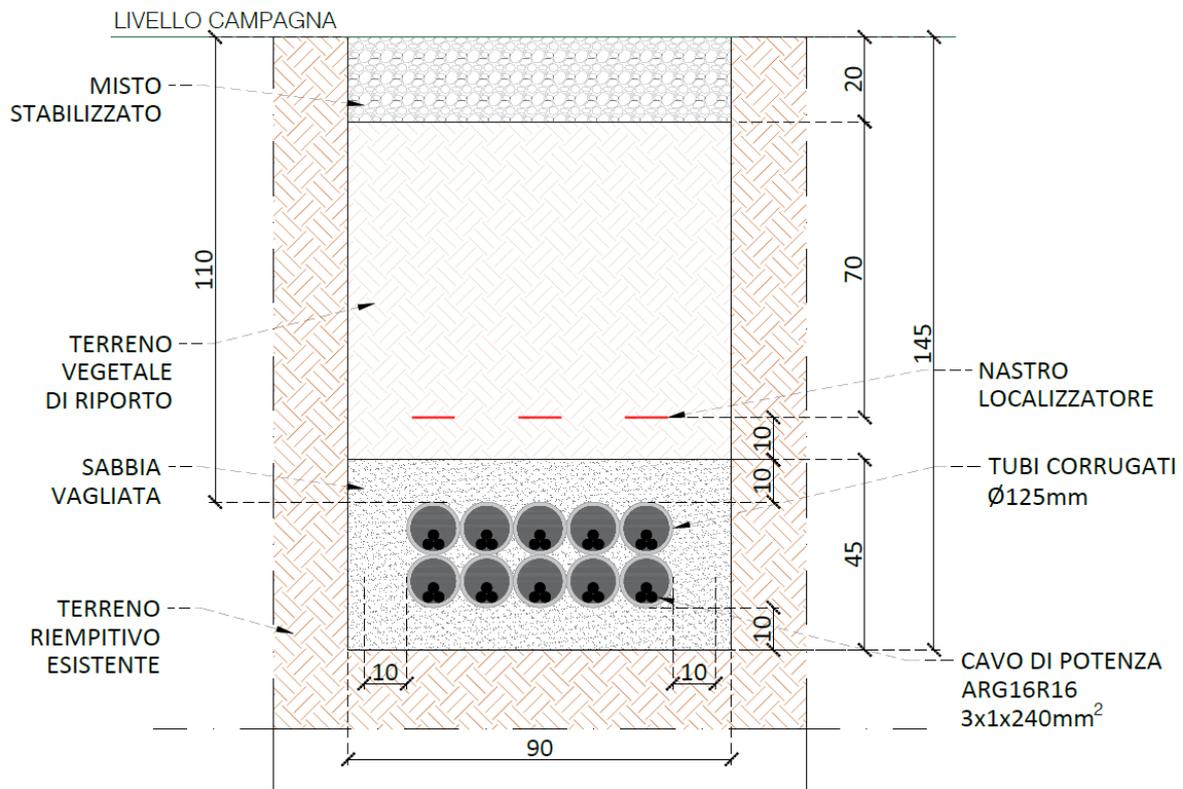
Sezione di scavo cavidotto BT 3x1x240 mm²
